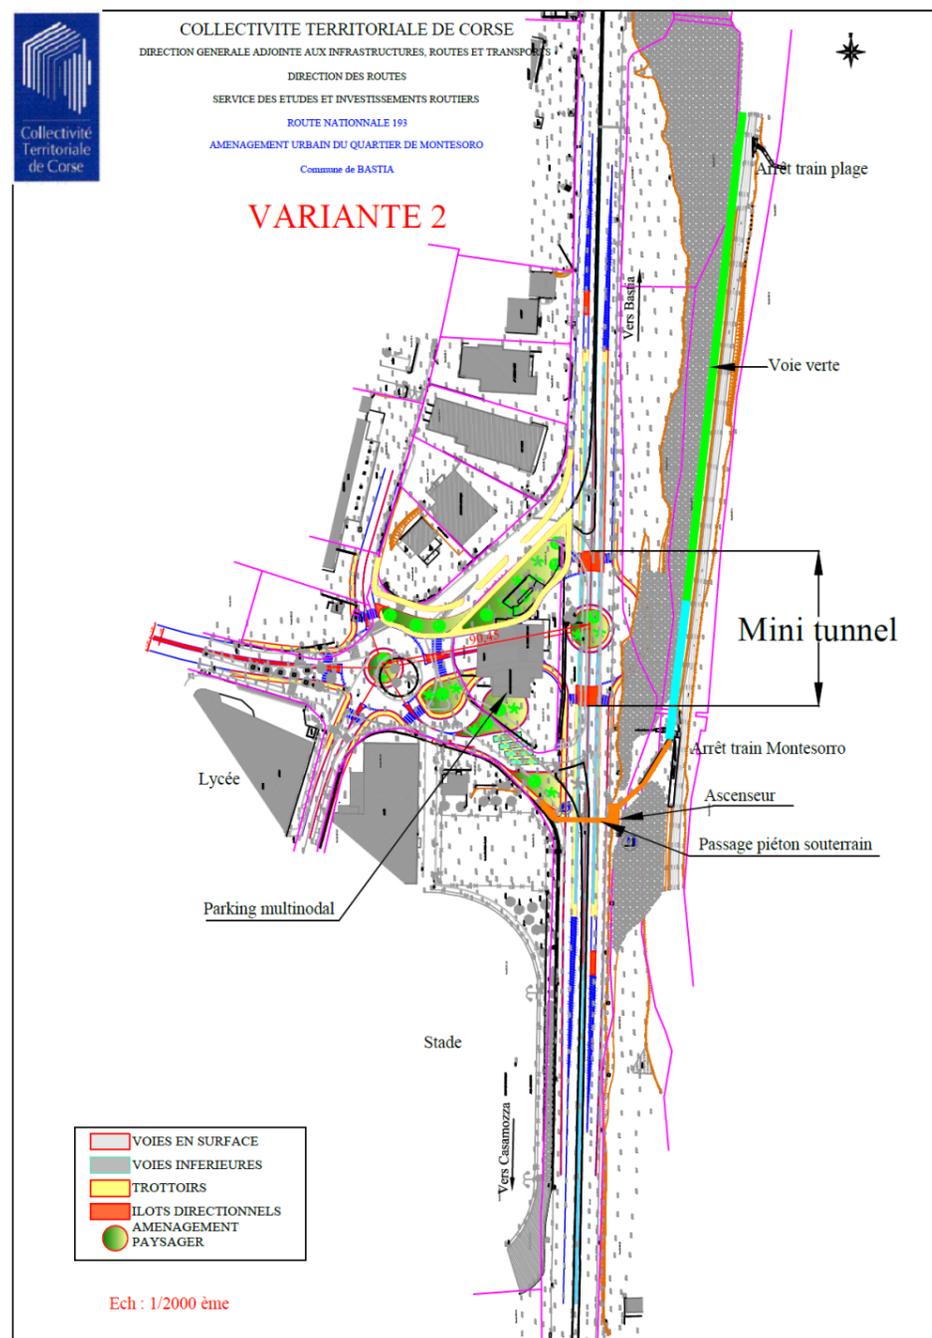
PLAN MASSE DE LA VARIANTE 2
